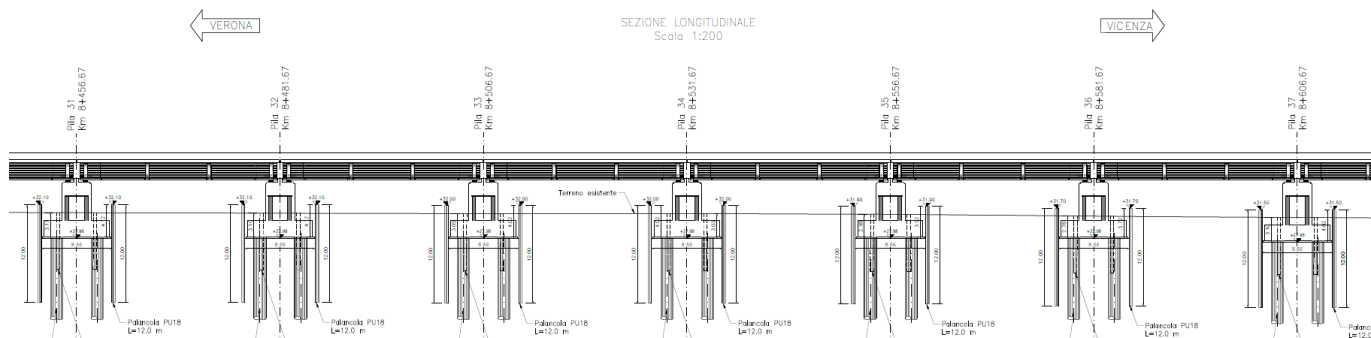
sezione longitudinale da pila 31 (iniziale) a pila 37
